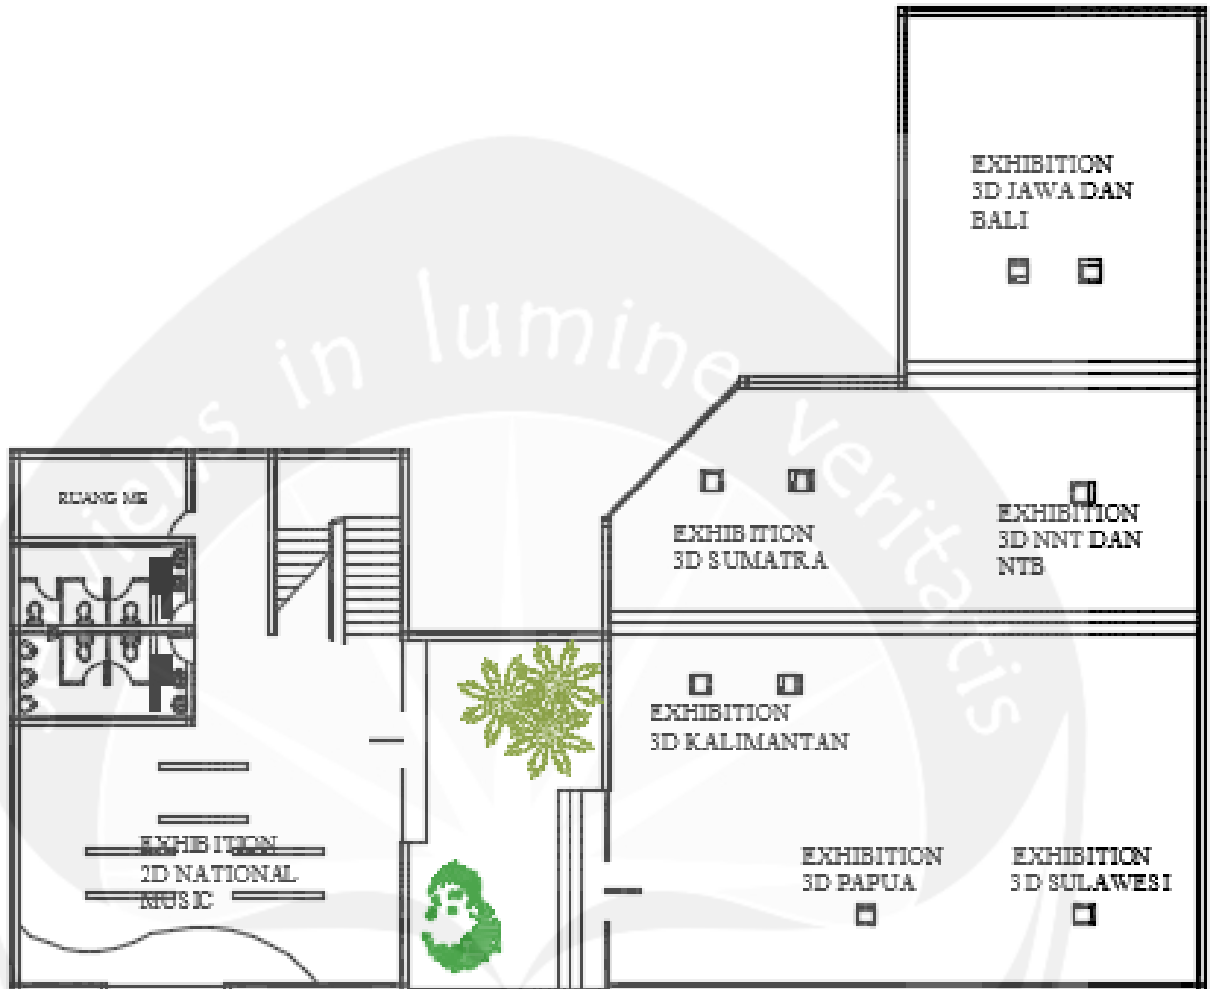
DenahMKMN lantai 1 bagian museum
